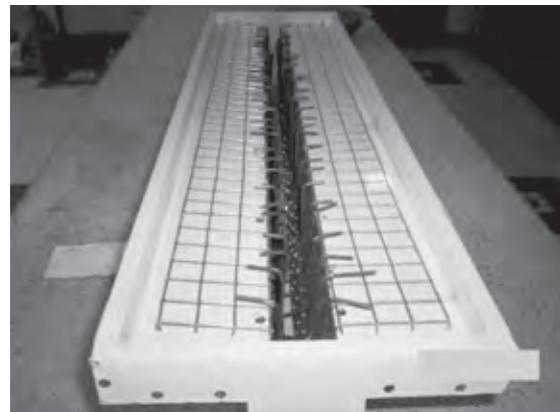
Detalle de la colocación de la armadura del refuerzo en la formaleta
